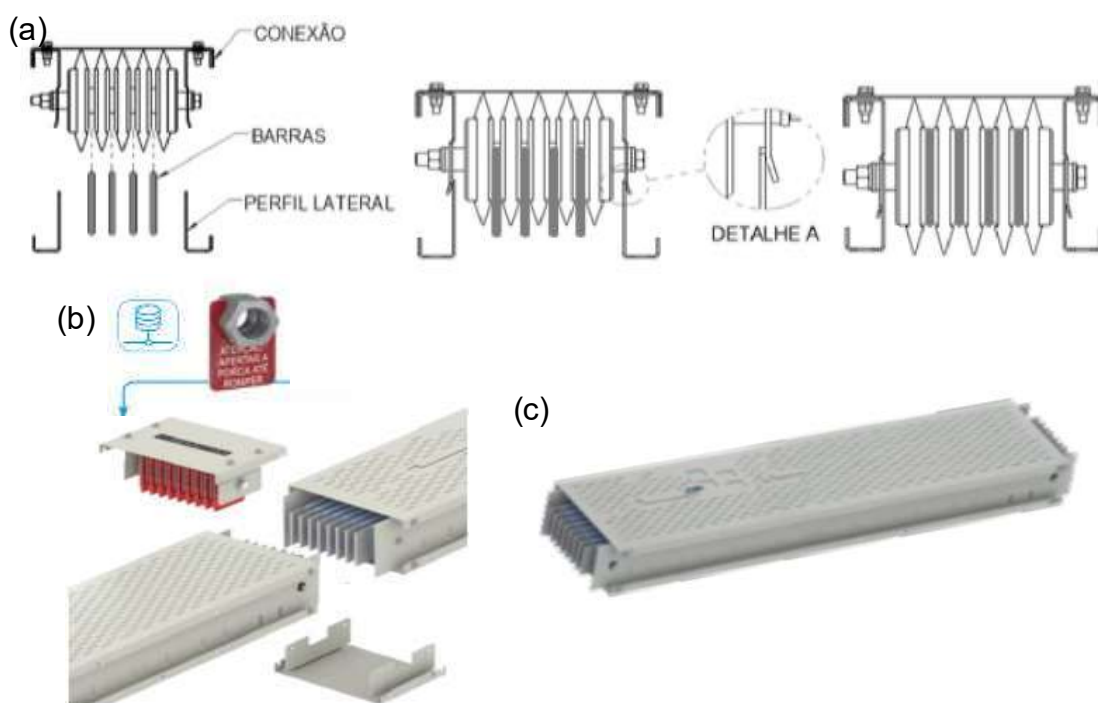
Conexões do barramento blindado: (a) montagem; (b) conexão e porca cisalhante; (c) junta de dilatação.
